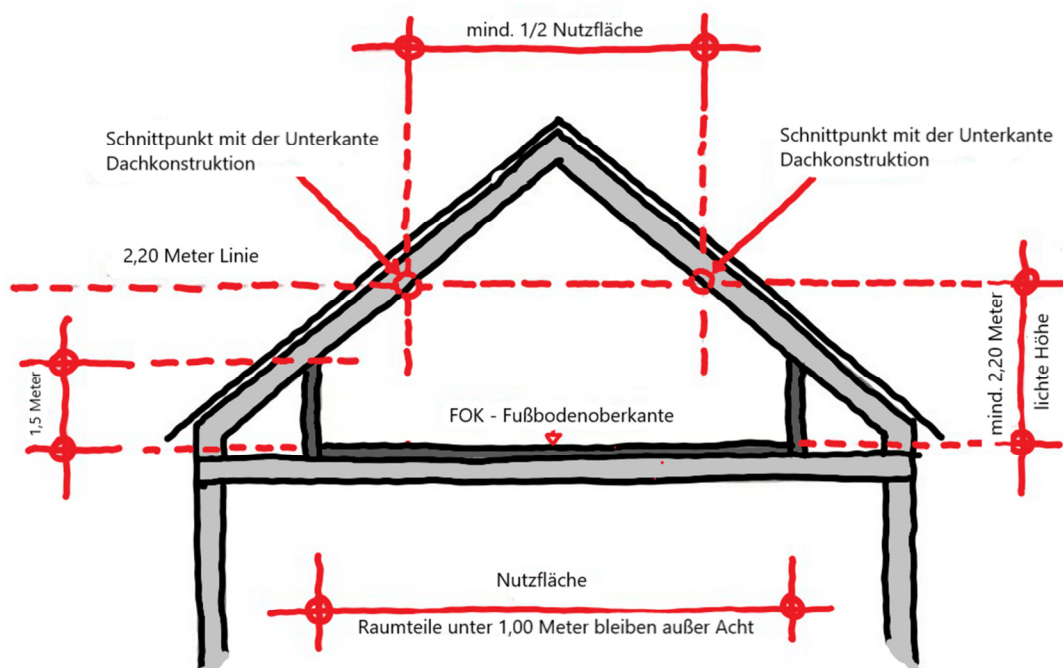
Wohnflächenberchnung bei einem Dachgeschossausbau
